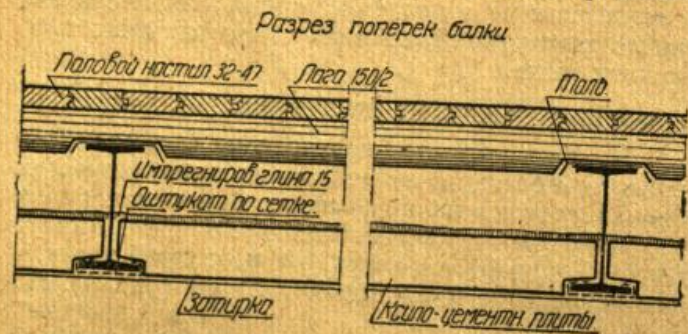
Междуетажное перекрытие с нижними кислцементными плитами.
